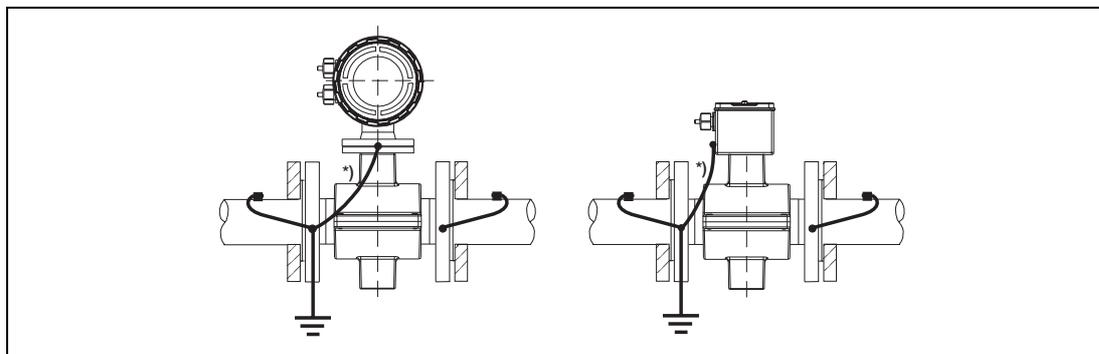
Aufnehmer DN 3 - DN 100 Flansch
